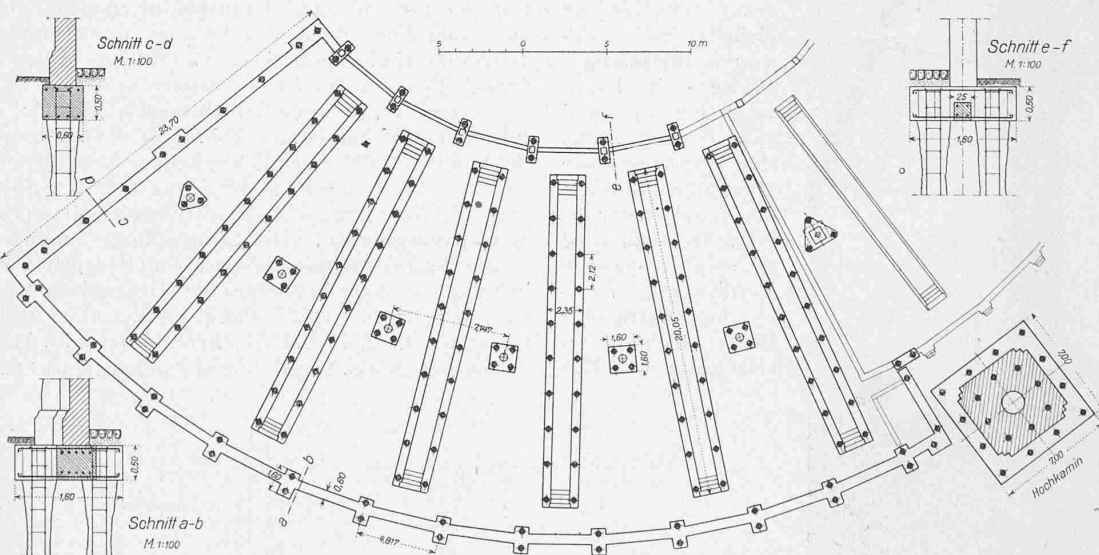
Grundriss der Lokomotiv-Remisen-Vergrösserung in St. Gallen 1:400 und drei Schnitte 1:100.
